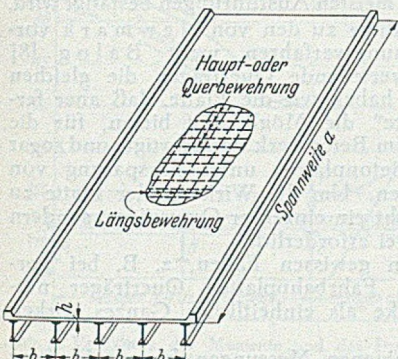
Schemaskizze einer Plattenträgerbrücke („slab and stringer bridge“).
